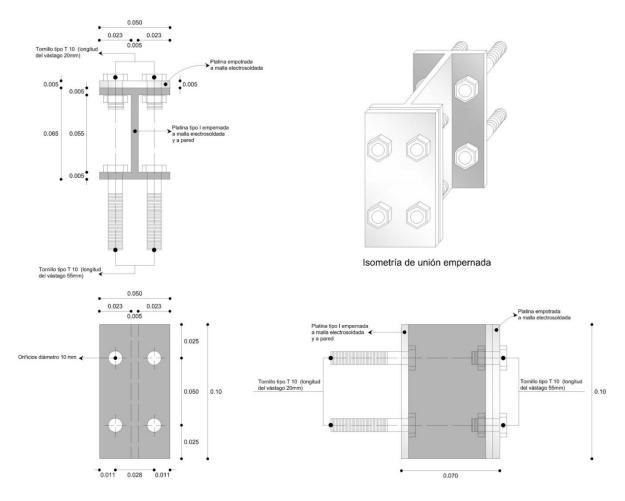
Detalle de platinas y pernos de sujeción para panel modular. Fuente: Eduardo Rivadeneira
